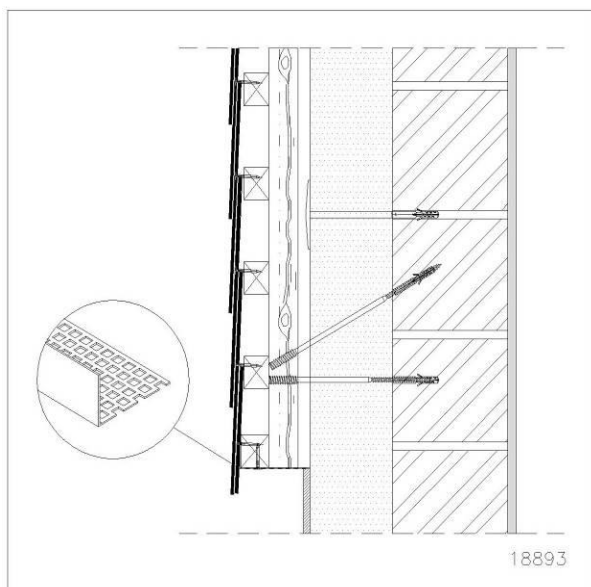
Bord inférieur – façade ventilée – coupe verticale
